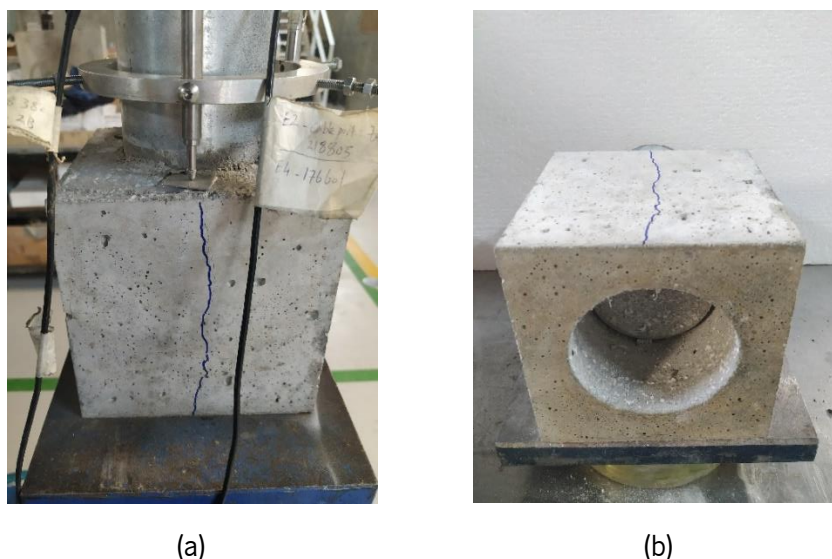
Fissura do provete M04_LB75_03
